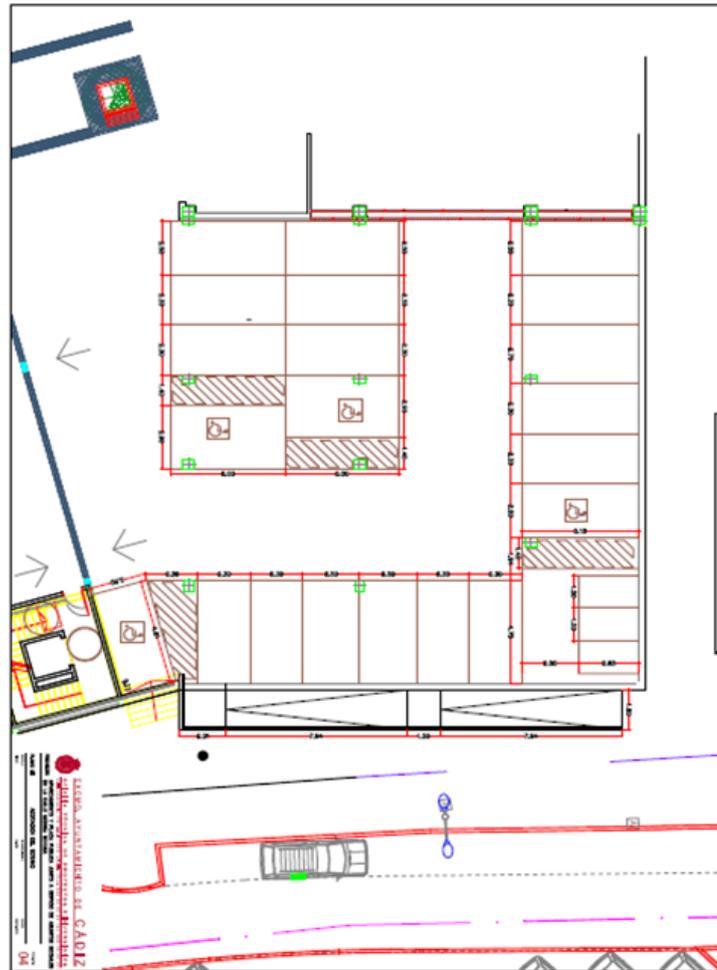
Plano general aparcamiento Plaza Segunda Aguada, Cádiz (Fuente: [24])
